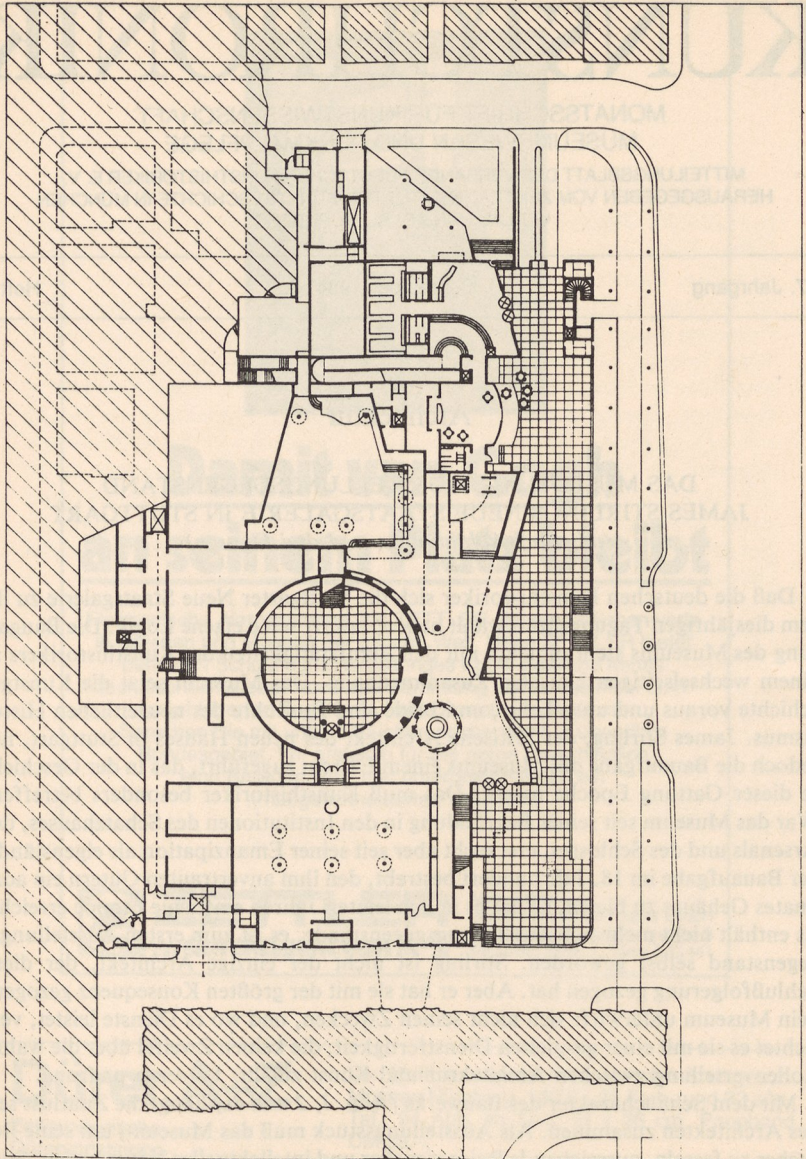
Neue Staatsgalerie Stuttgart. Grundriß Erdgeschoß (nach: Neue Staatsgal. u. Kammertheater Stuttgart, Stuttgart 1984, S. 18)
